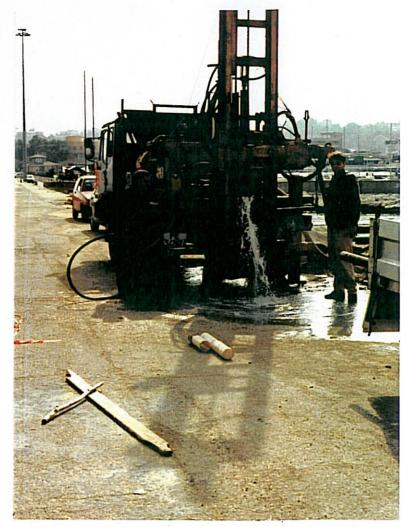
Esecuzione di preforo a distruzione di nucleo per prova penetrometrica CPT n° 5
